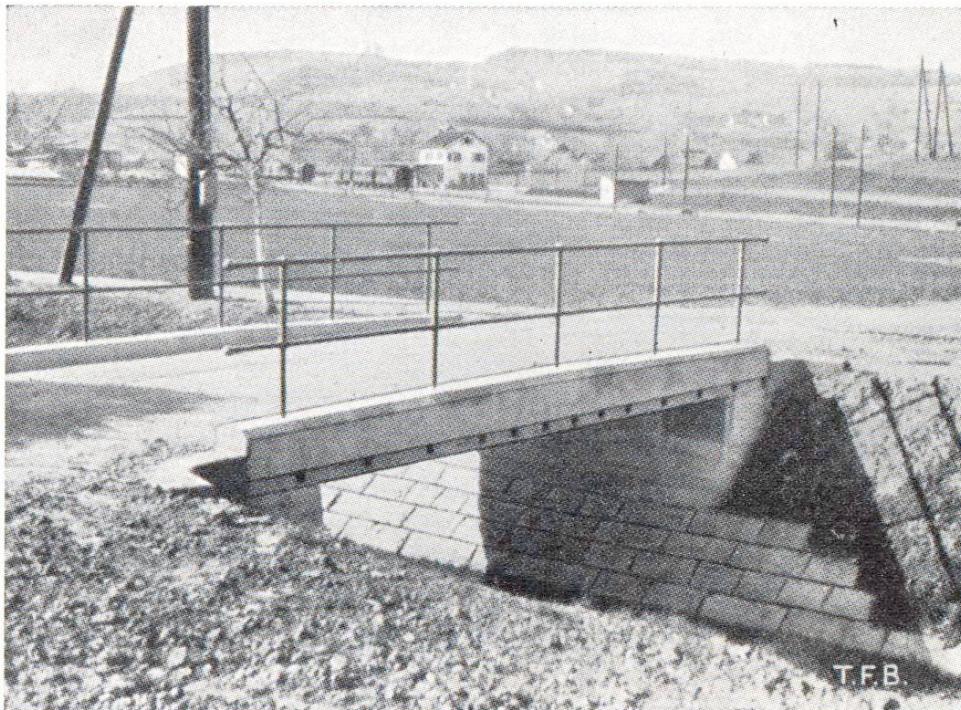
Pont-route construit en béton précontraint. Armature précontrainte en câbles d'acier
